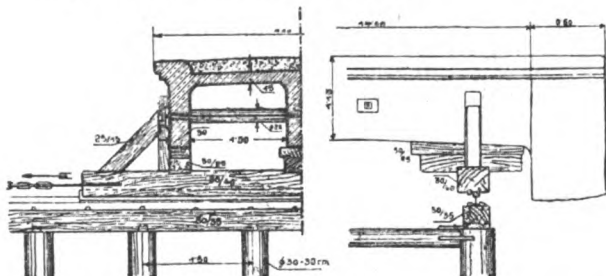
Spostamento di un ponte in cemento armato. - Disposizione generale.
